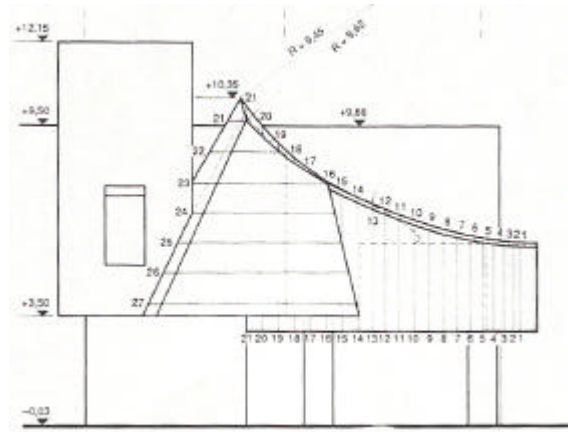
Frank Gehry, Fabrikationshalle, 1987-1989, Dachdetail der Nordecke von Nordosten
